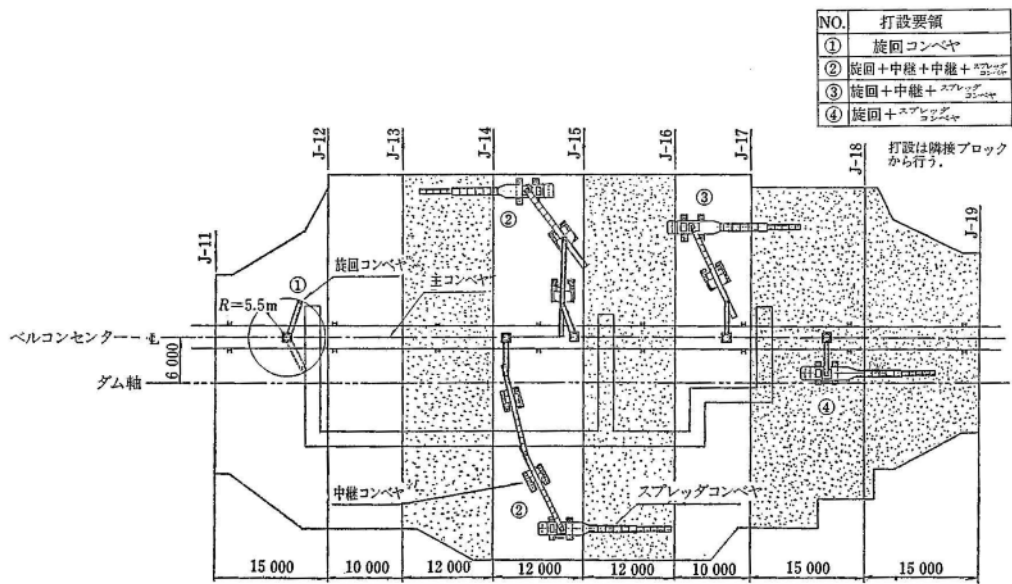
3 - 11 BCP 工法における打設平面図 (高滝ダム)
